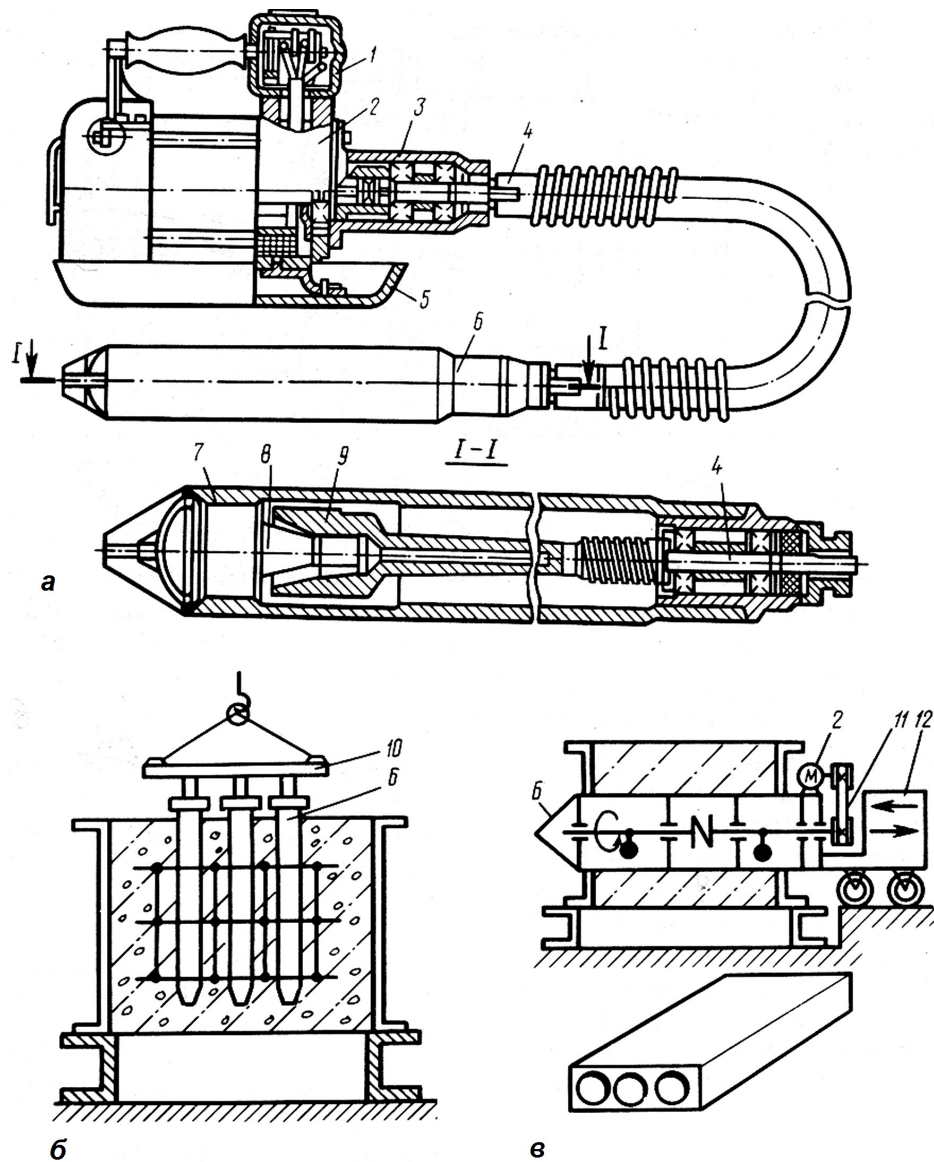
Обладнання для глибокої обкатки суміші: а – глибокий віброзбуджувач; б – пакет глибоких віброзбуджувач; в – порожниноутворювач;
